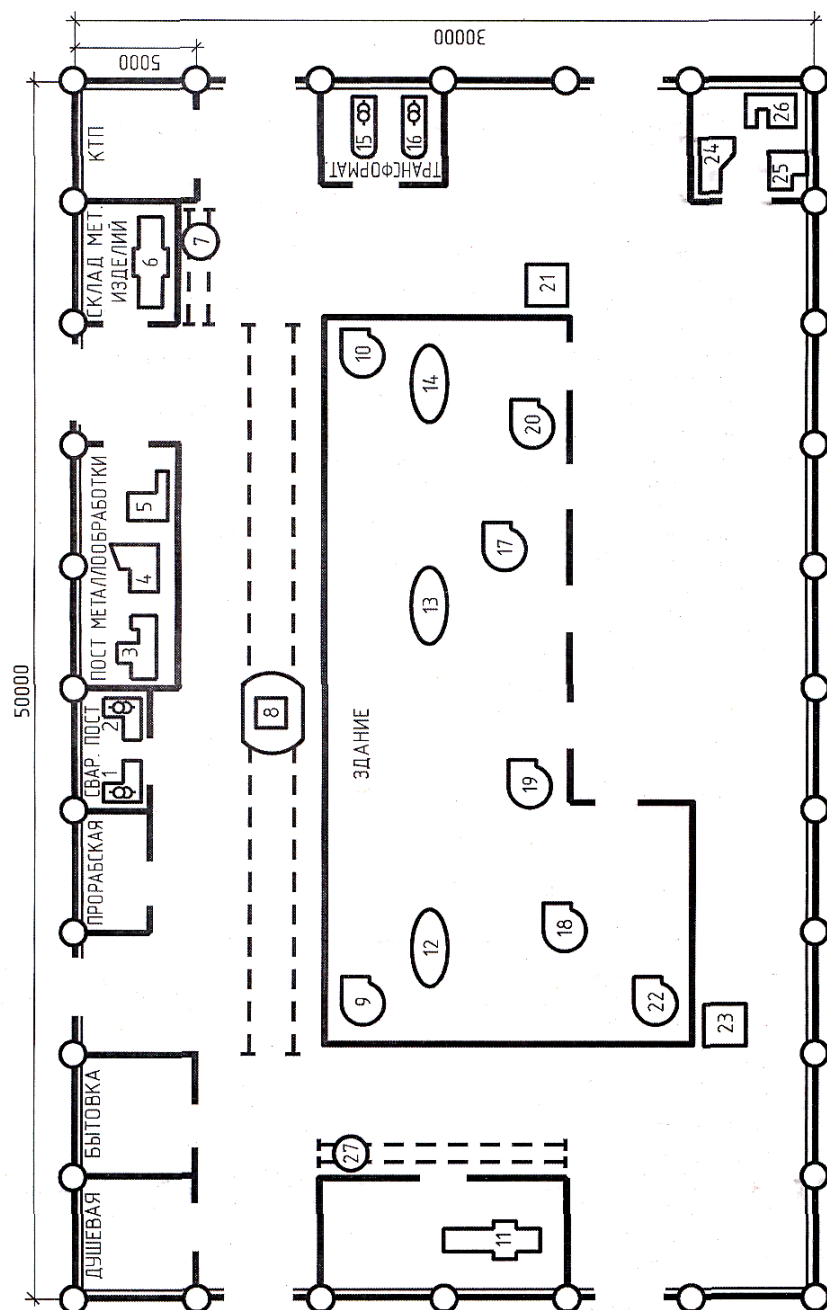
План расположения ЭО строительной площадки жилого дома
